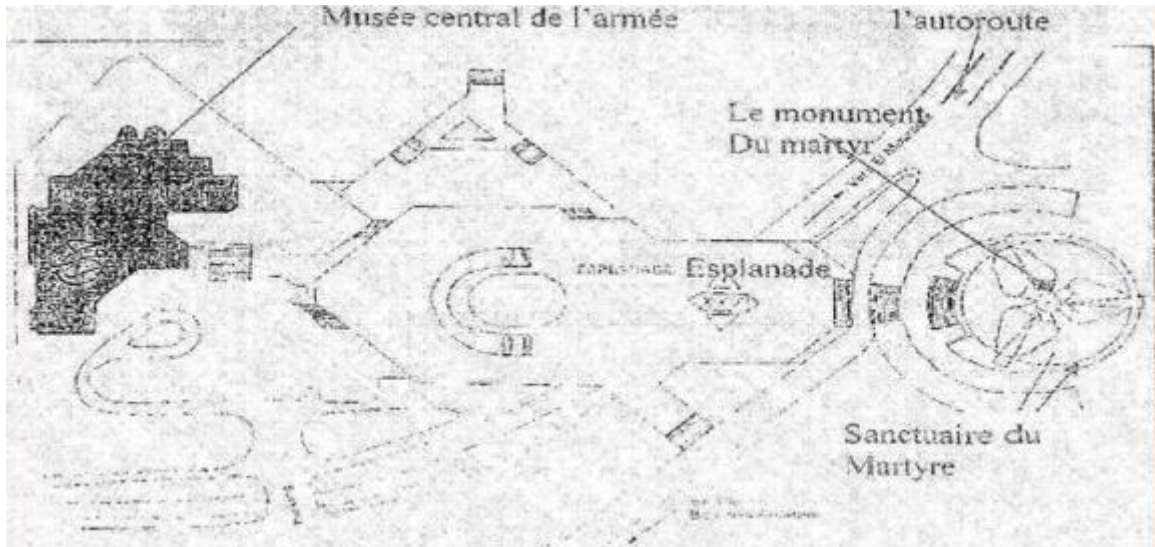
Plan de masse du centre de RIAD EL FETH . (Source : Archdaily.com)
